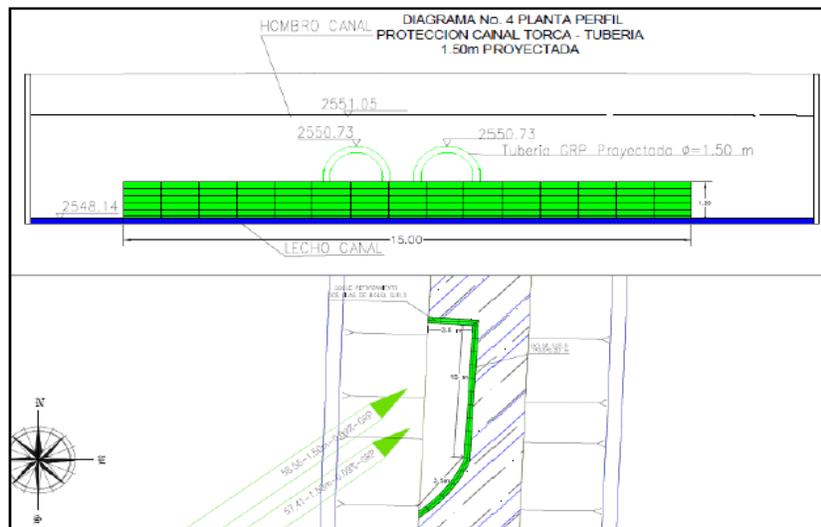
Diagrama planta - perfil de protección del canal Torca – Tubería occidental -1.50.
